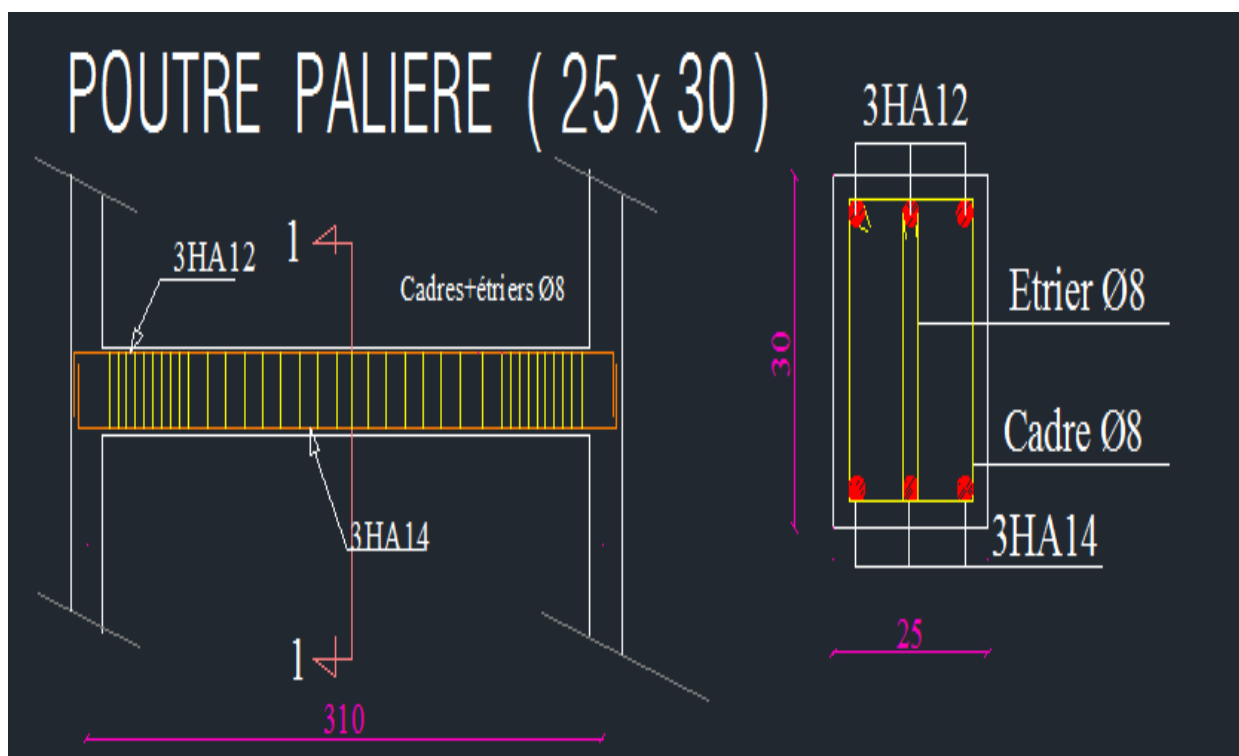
Schéma de ferrailage de la poutre palière.
